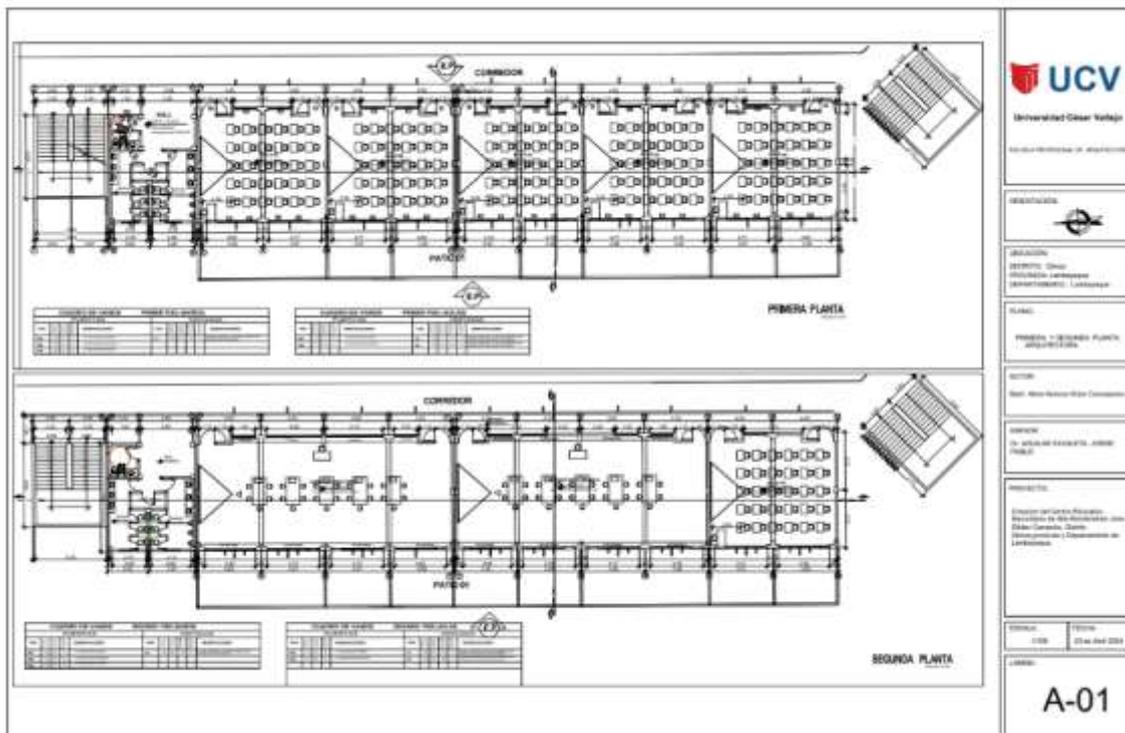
Planos De Distribución Por Sectores Y Niveles - Sector Aulas
